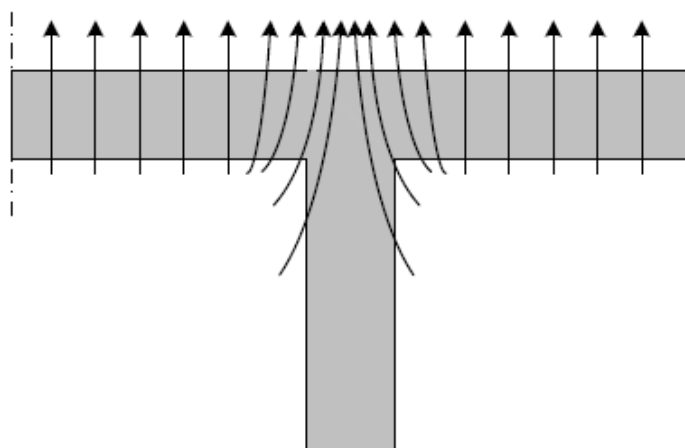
Ponte térmica na zona de um encontro de paredes (interior/exterior)
